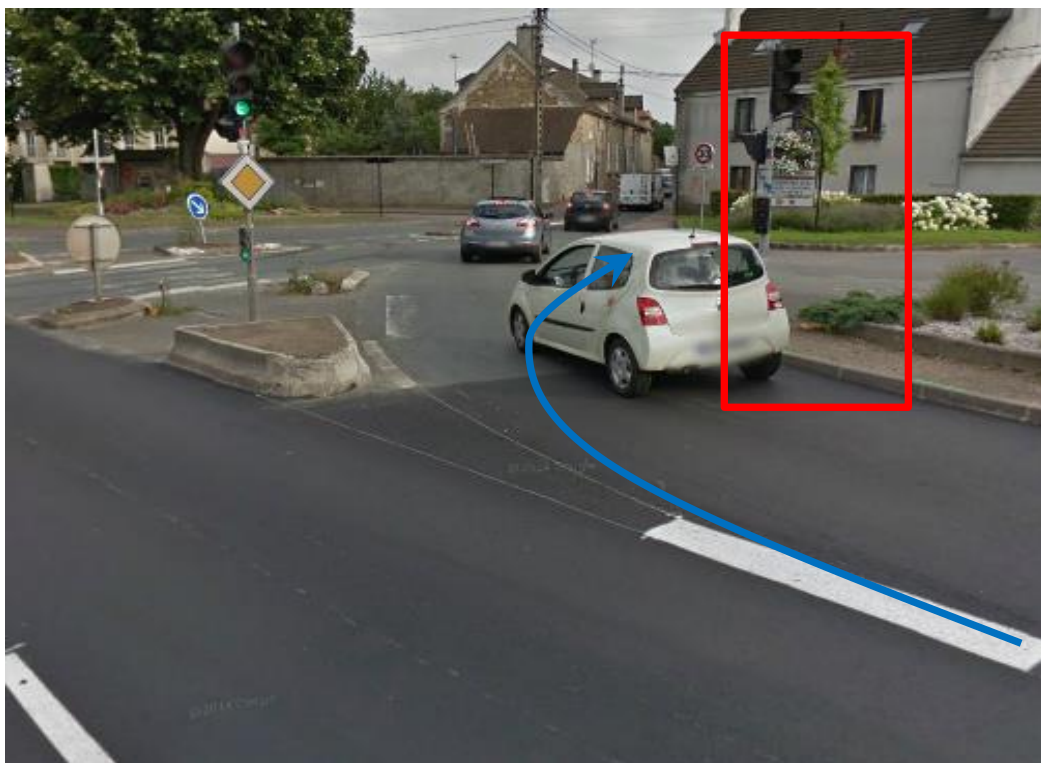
Ruta en azul. Hacer desmontable el elemento indicado.
